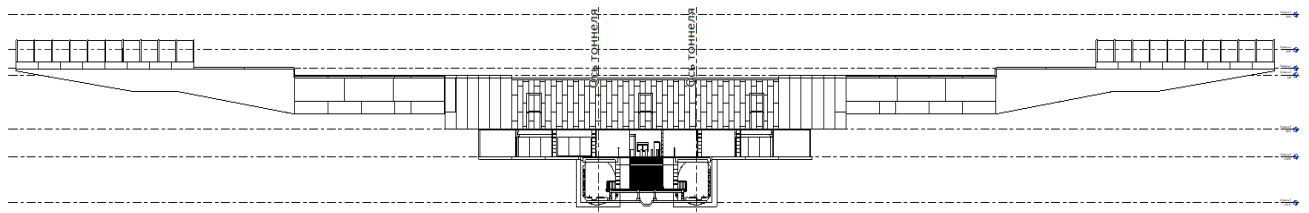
Архитектурно-планировочное решение (фасад - южный)
